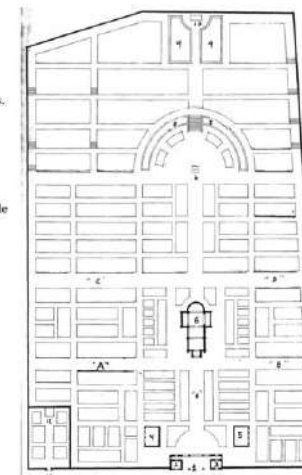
Plano de J.M. de la guardia del cementerio de grado
